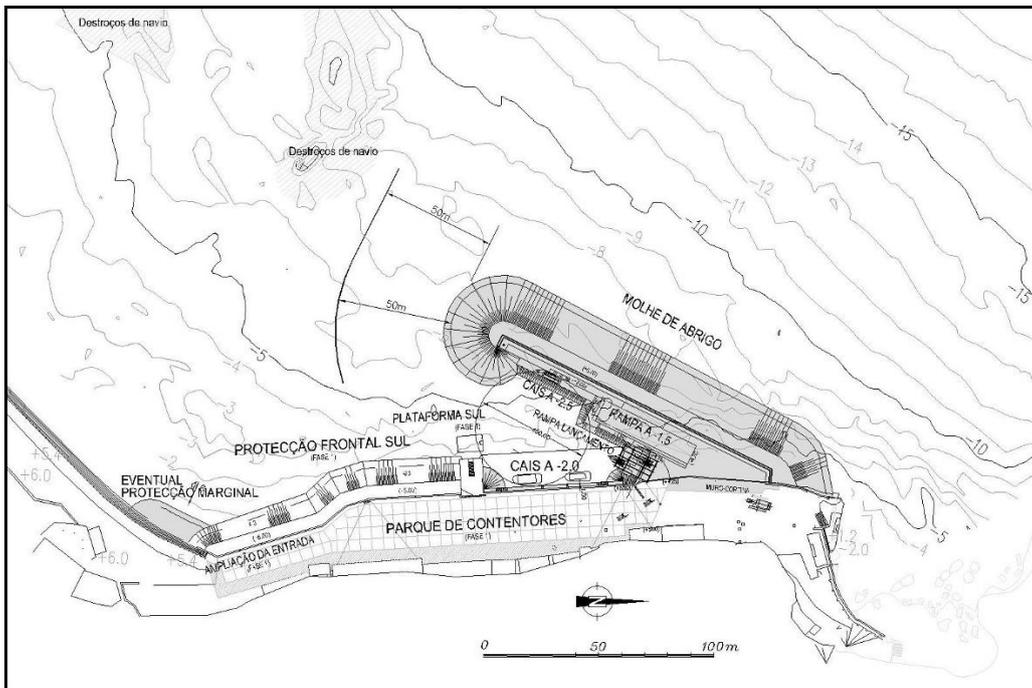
Planta de arranjo geral da Fase 2 (solução B)
